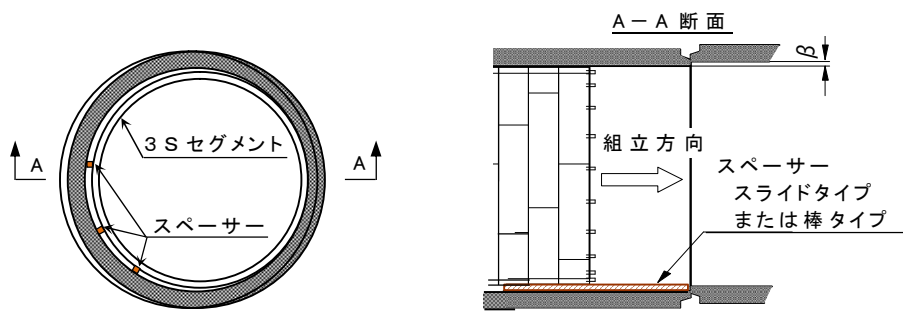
呼び径の2%以下の段差の継手部施工方法
